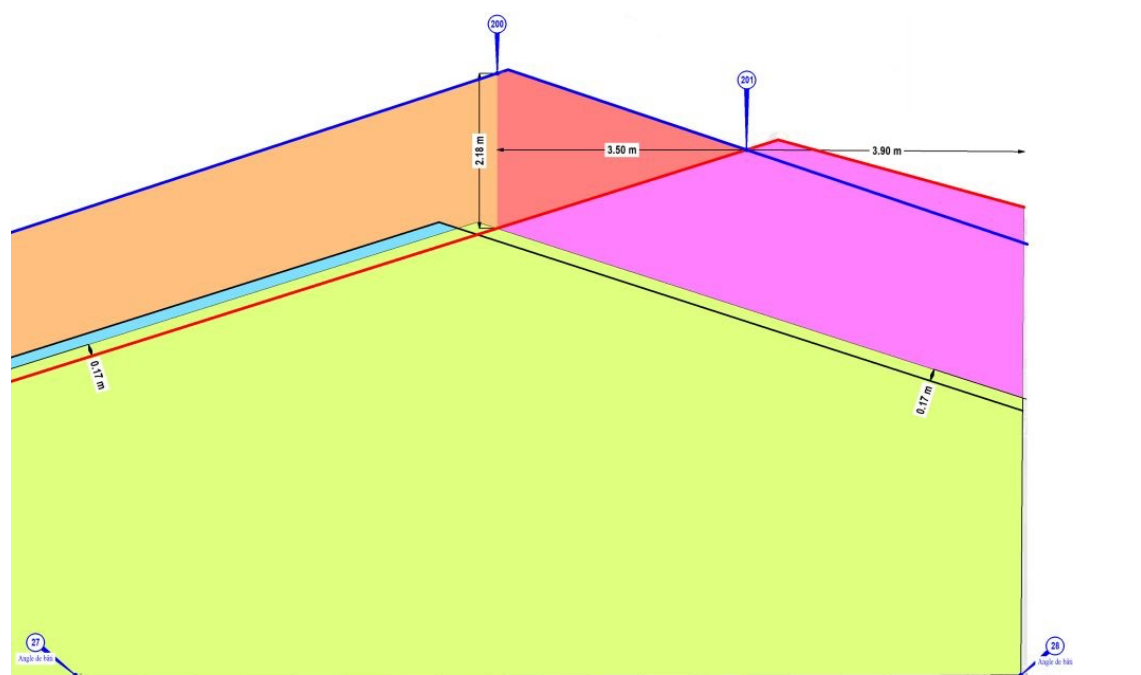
Plan d'héberge (figure de mur) et sa légende
